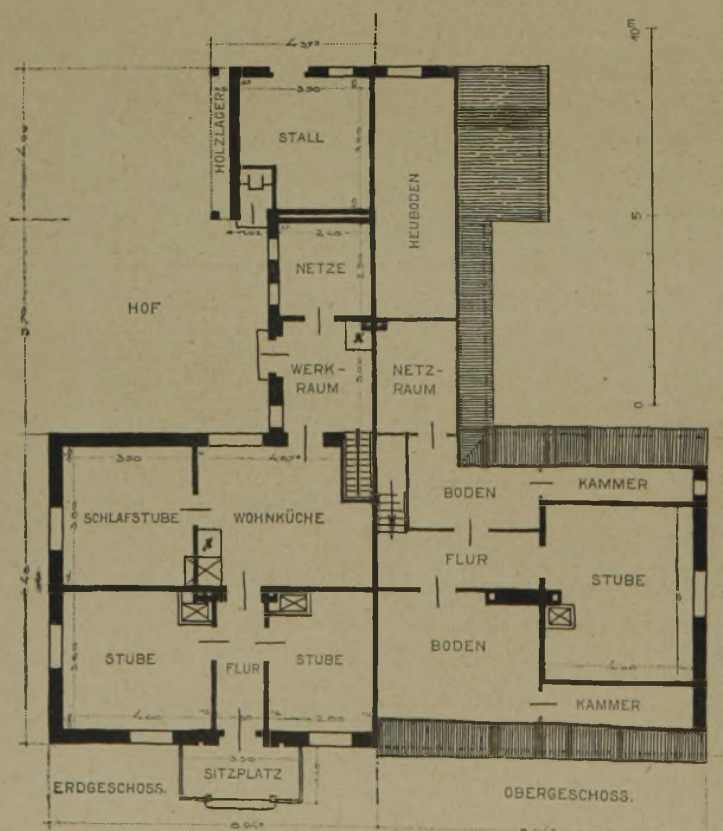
Grundrisse vom Erd- und Obergeschoß.
